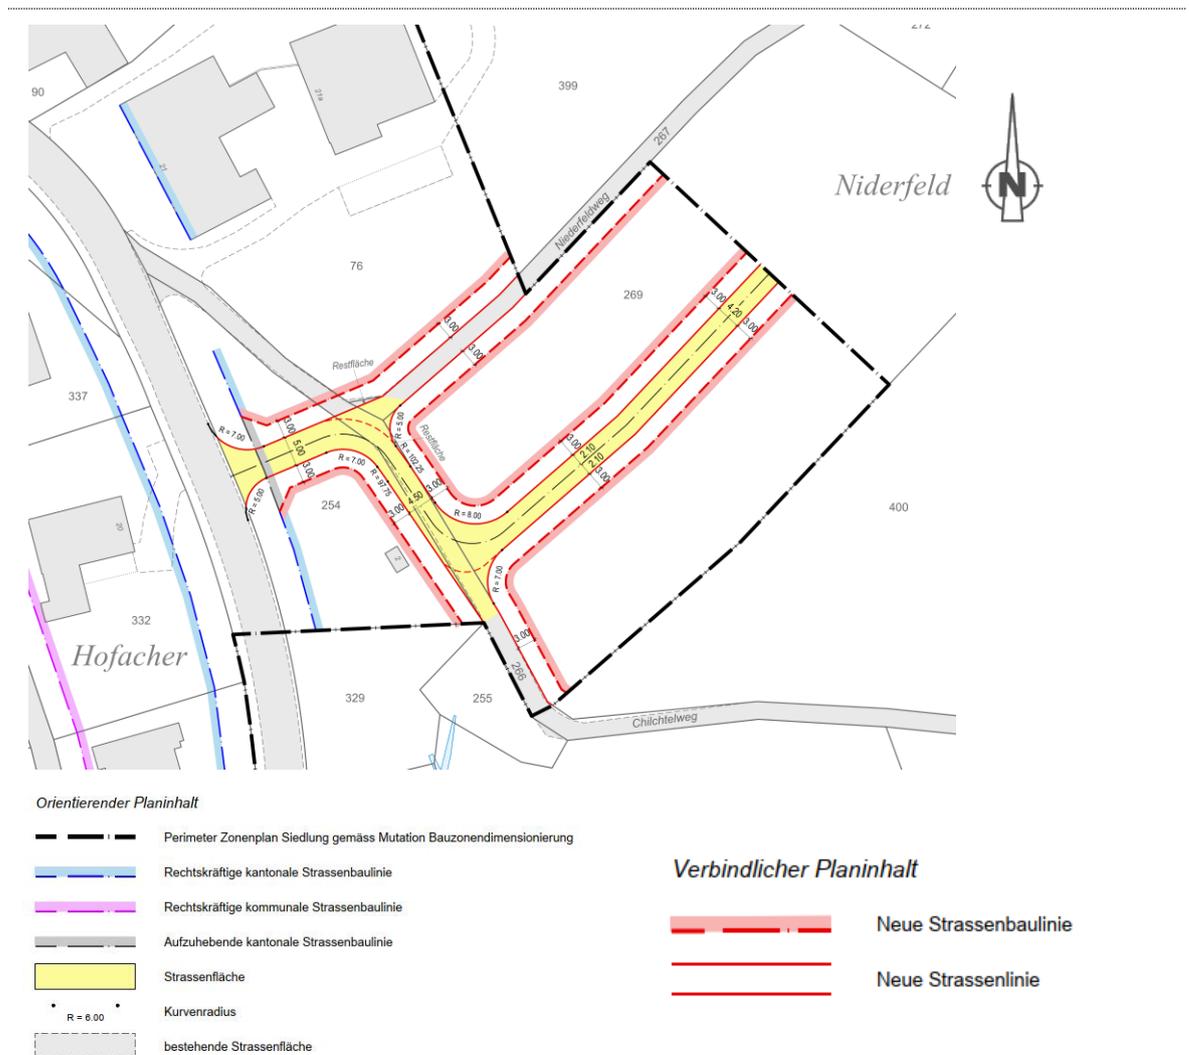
Ausschnitt Bau- und Strassenlinienplan Niederfeld
